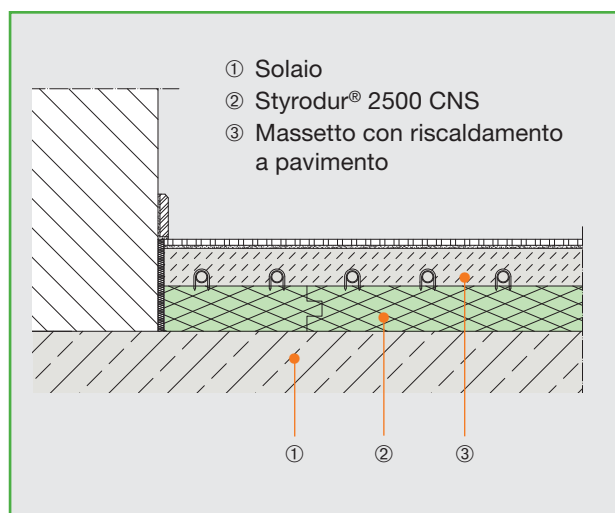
Realizzazione di un pavimento con Styrodur® 2500 CNS e riscaldamento a pavimento
